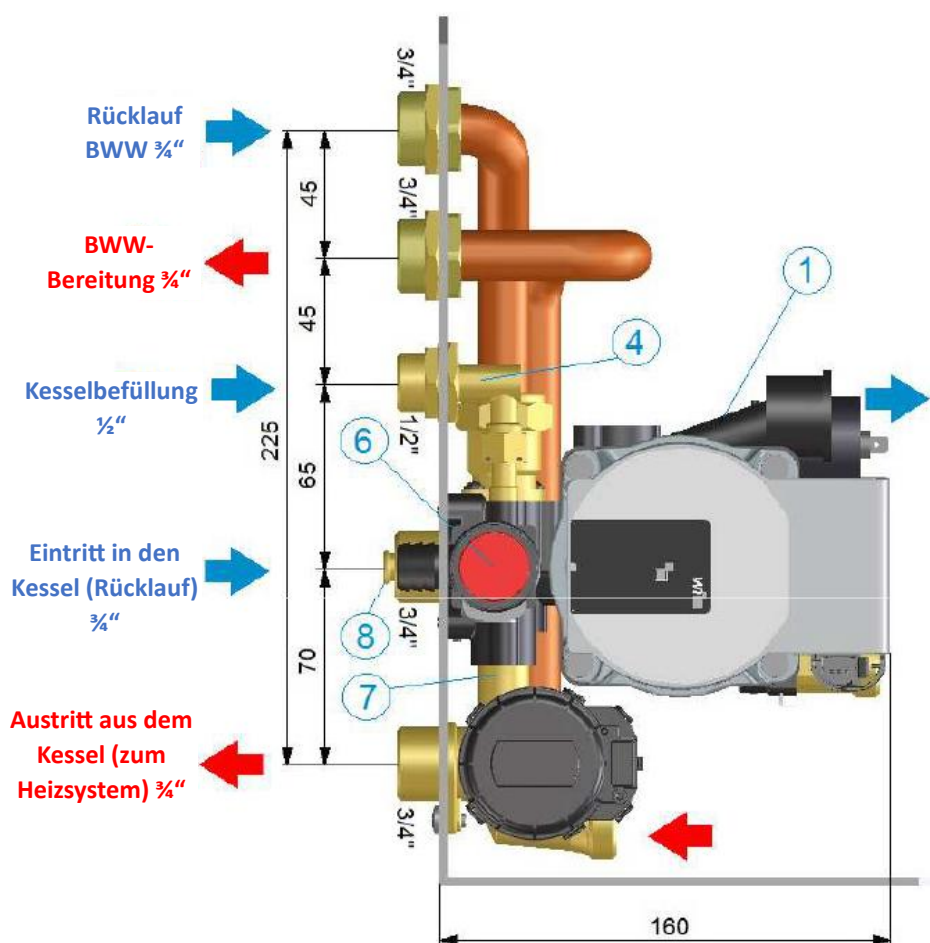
Anschlüsse des Kessels ohne Pumpengruppe, mit:
